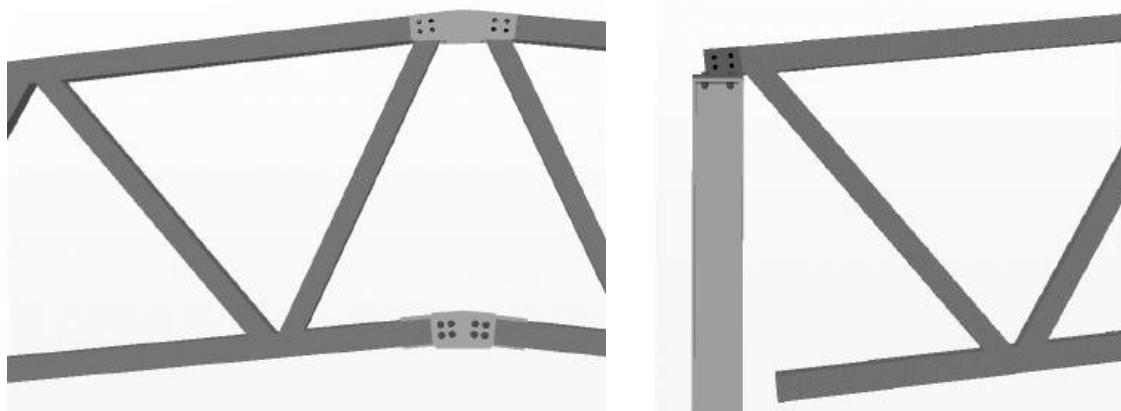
Assemblages permettant l'utilisation de treillis sur différentes pentes [31]
